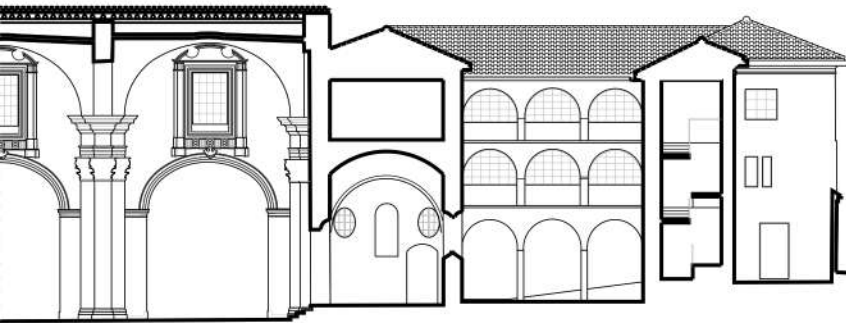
Catedral Primada de Bogotá. Sección Longitudinal B, Sección Transversal C y Fachada (Autor, 2025).
